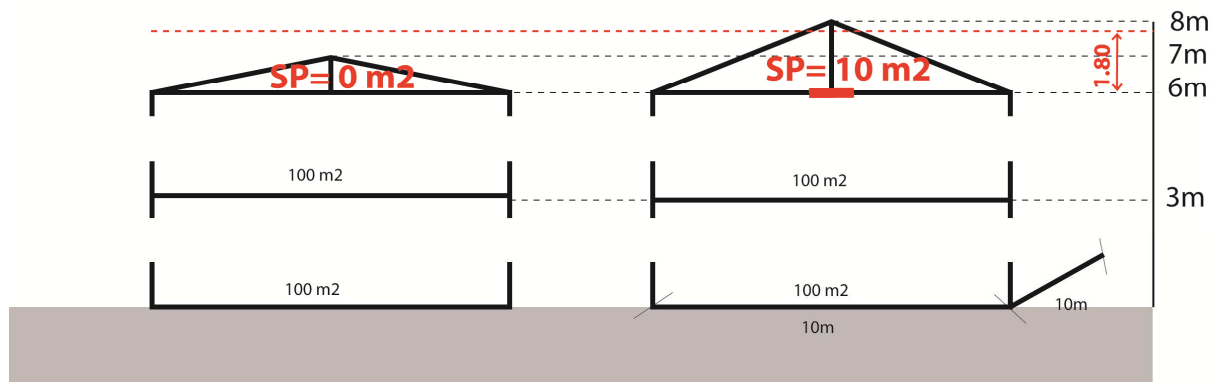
Surface de plancher générée par l'augmentation de la hauteur à 8 m
